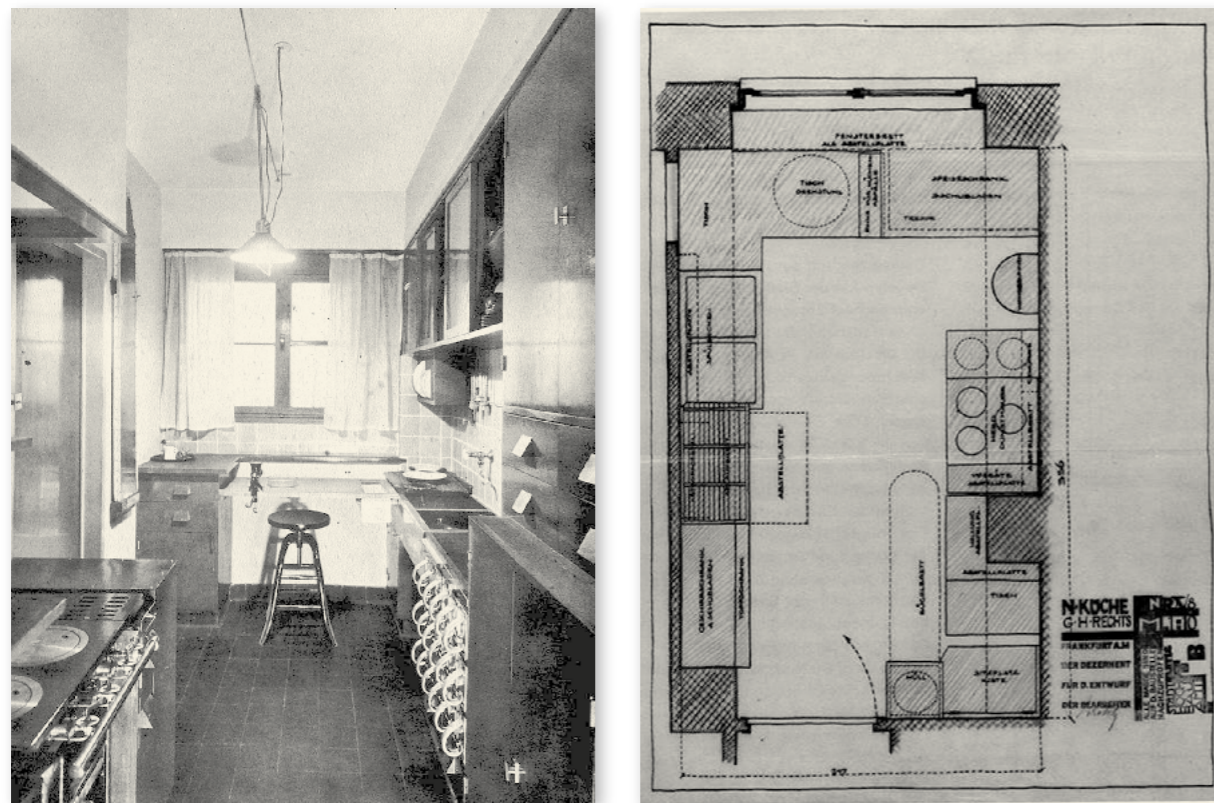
Cocina Frankfurt. Planta y vista interior (Schütte-Lihotzky, 1925)
